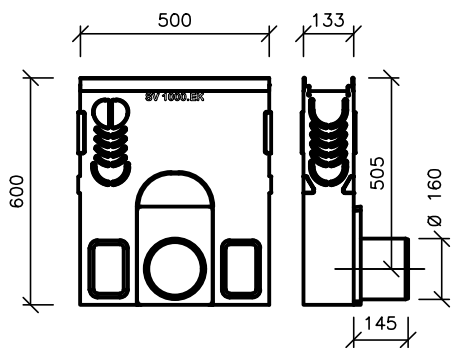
DETAIL BOČNÍ ŠTĚRBINY TSH 1000/160
